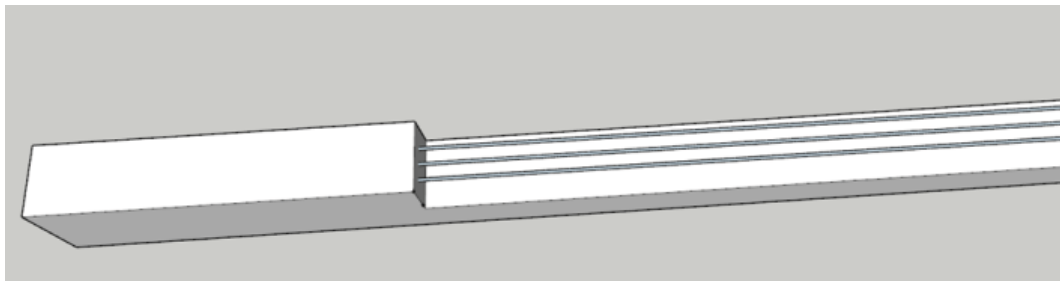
Схема ділянки балки з локальним недобетонуванням
